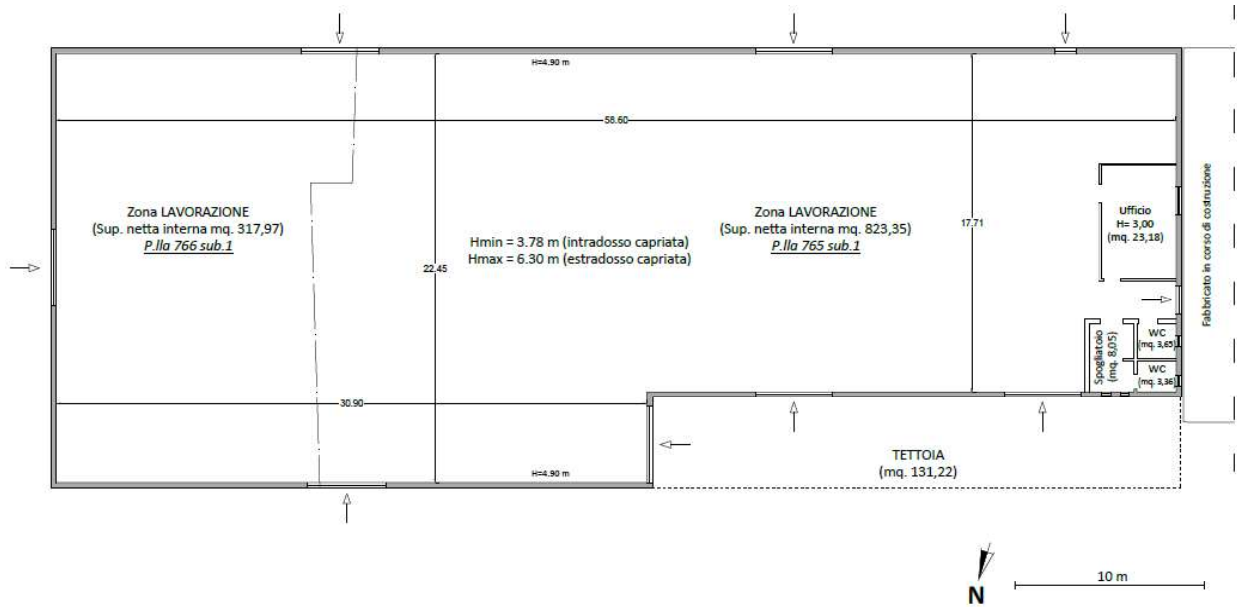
Planimetria stato reale rilevato – Opificio: F.23 P.Illa 765 sub.1 e P.Illa 766 sub.1
